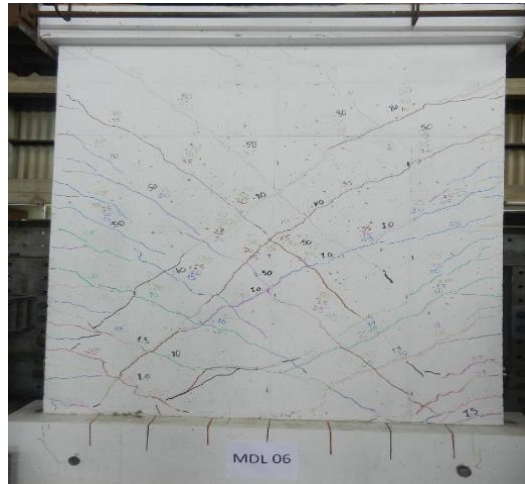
Muro en estado de daño límite 2 [18].
